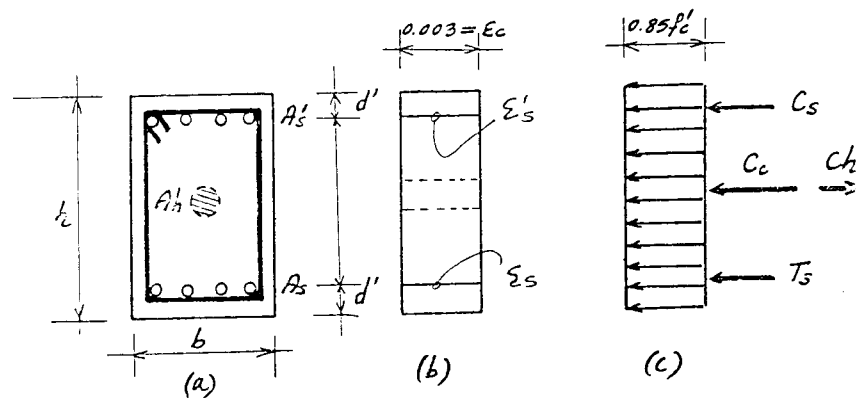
a) Sección Transversal; b) Deformación del Concreto; c) Fuerzas concreto y acero
